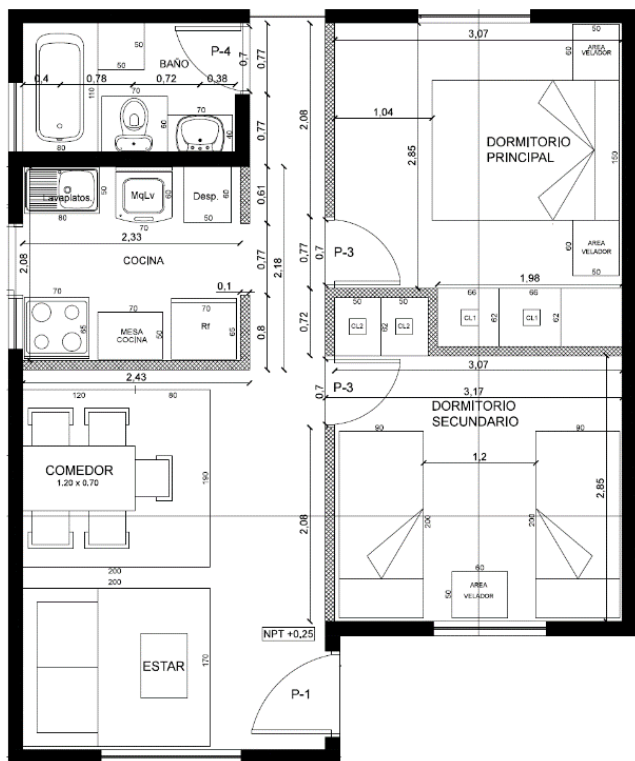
Planta de la vivienda de estudio, muros achurados en negro corresponden a la albañilería y en color claro a la tabiquería interior.
